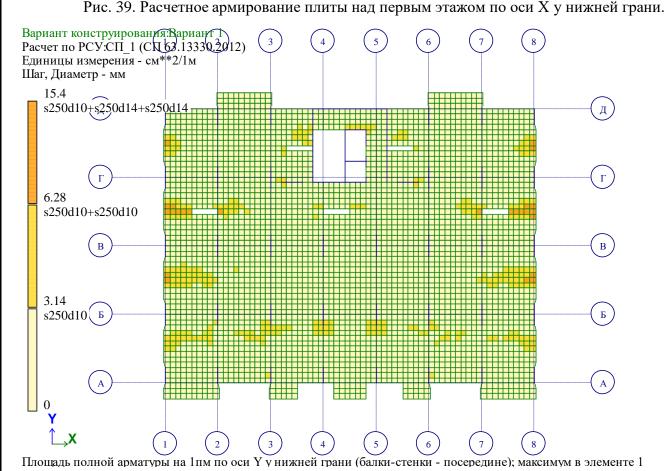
Расчетное армирование плиты над первым этажом по оси Y у нижней грани.
